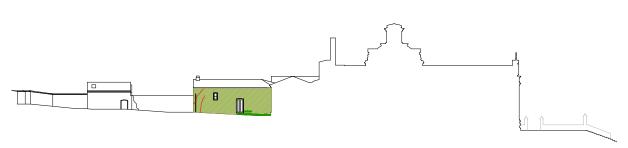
Relevamiento de lesiones - Fachada interna Sur II
